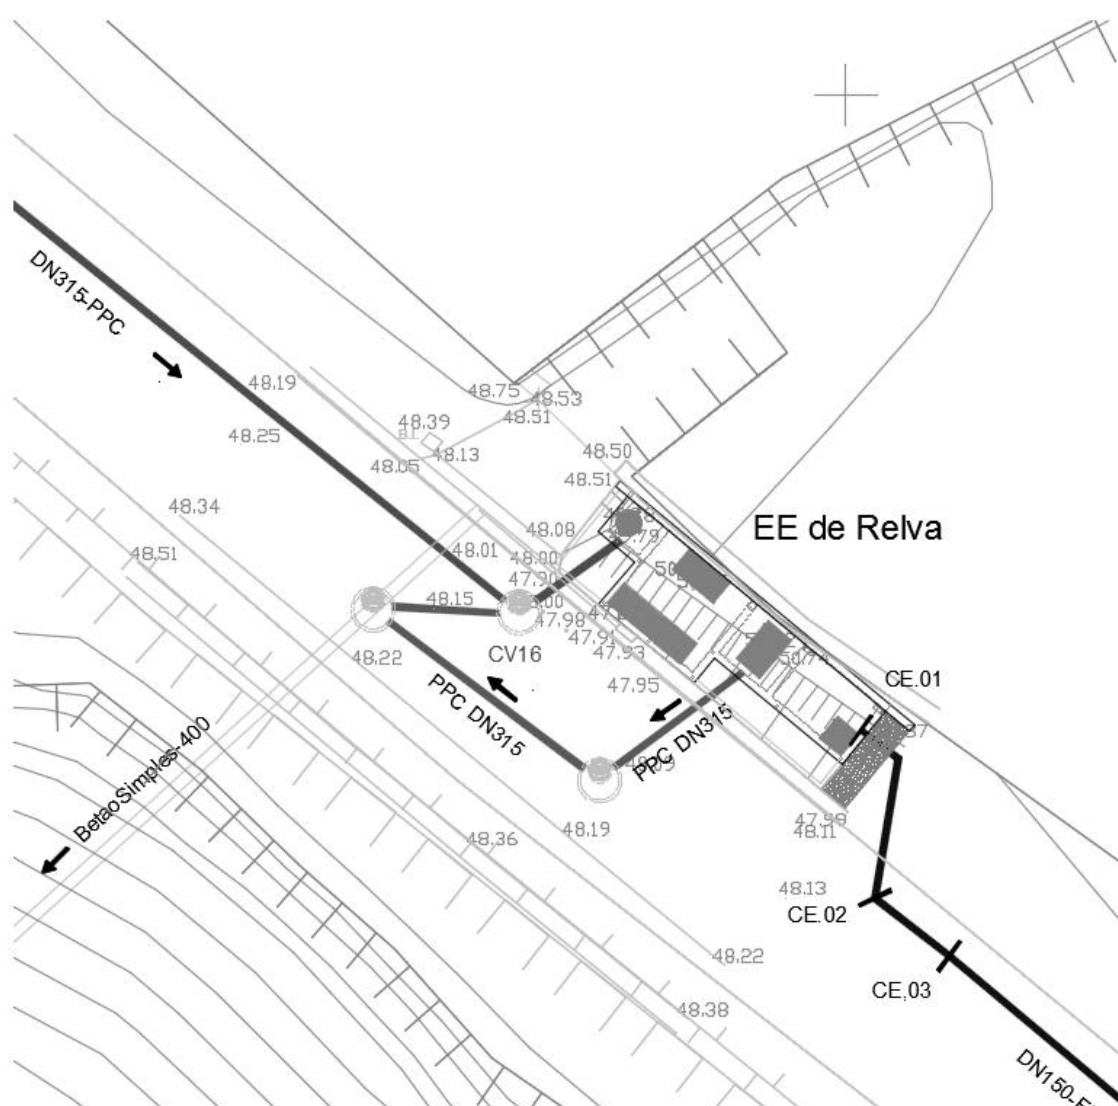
Planta de implantação da Estação Elevatória de Relvas.
